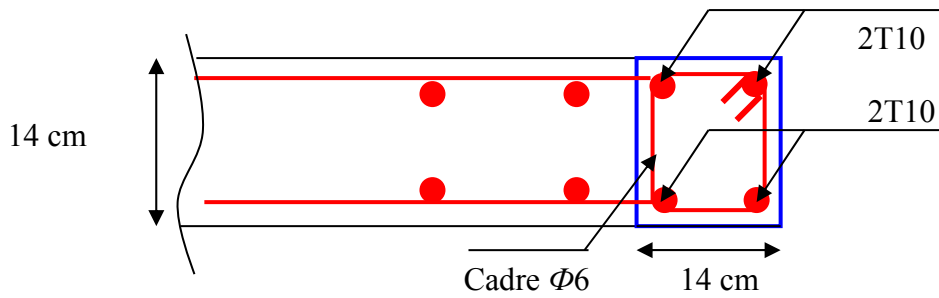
Schéma de ferrailage de la poutre noyée (Chevêtre)
